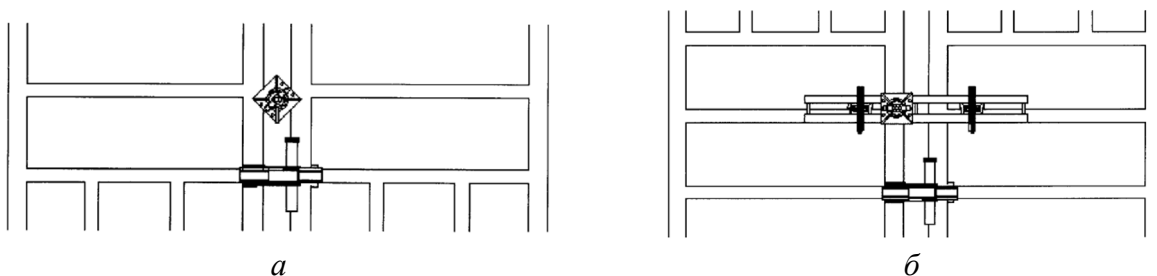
Пример установки стяжек: *а* – распределение усилий через подкладочную пластину; *б* – распределение усилий через ригель
